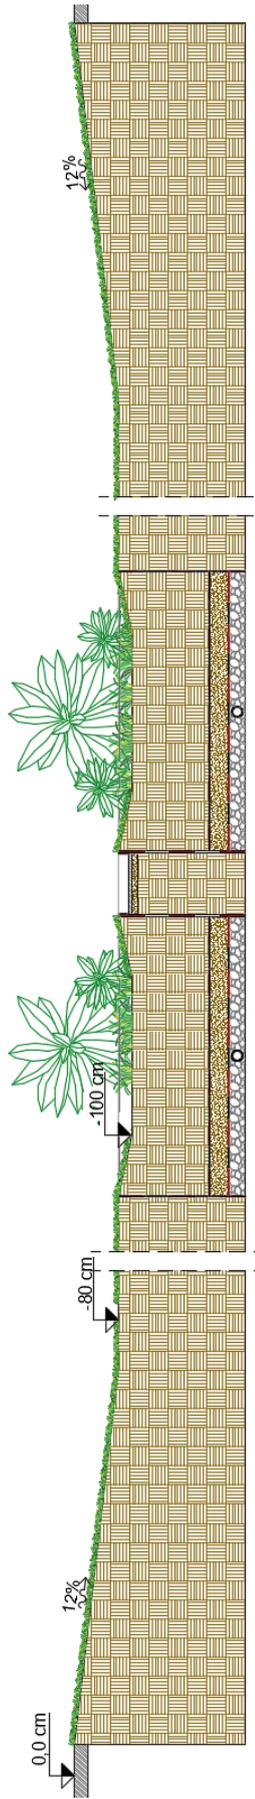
Sezione trasversale bacino 3 (Realizzato con AutoCAD 2023)
